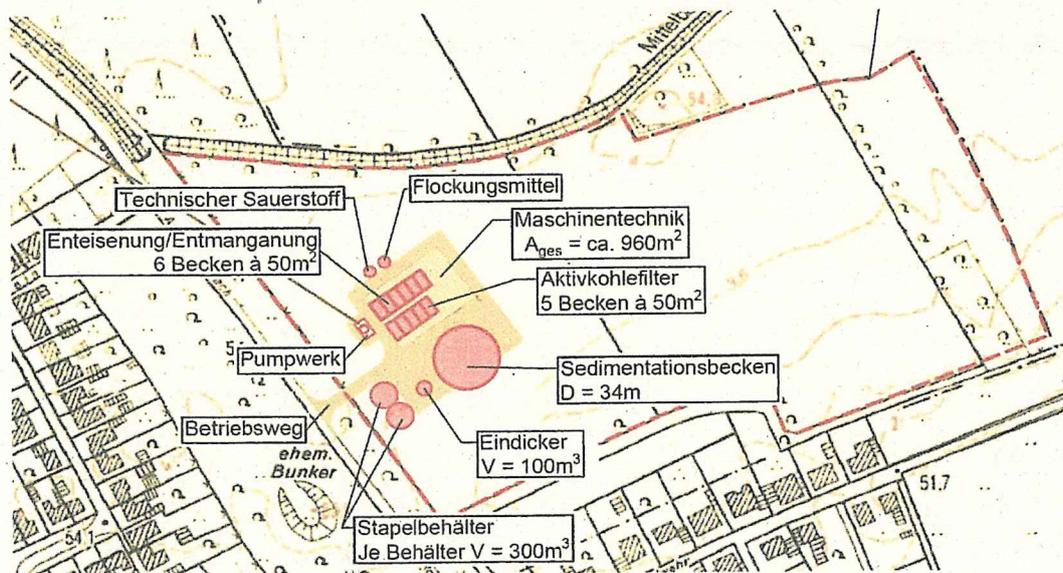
Lageplanskizze Grubenwasserbehandlung Haus Aden Variante B
